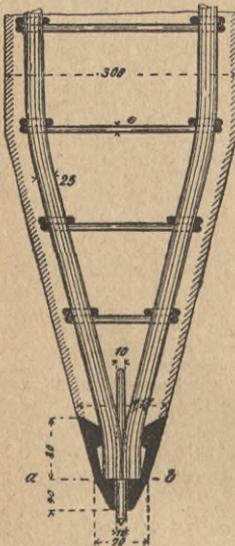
Eiserner Schuh für Eisenbetonpfähle.
